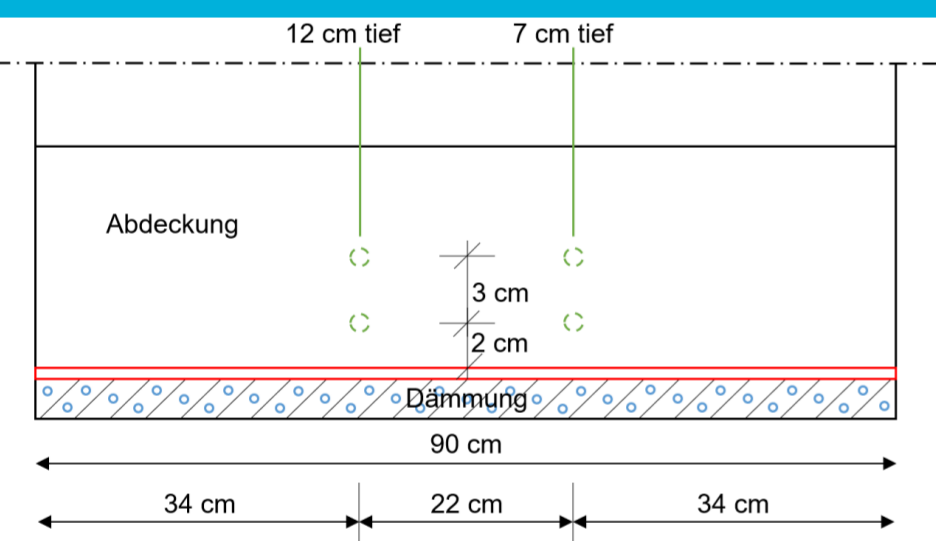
Draufsicht auf die Brettsperrholz-Deckenplatte im Auflagerbereich (grün: Einschraubelektroden, rot: Flachbandsensoren, blau: Wasser)
